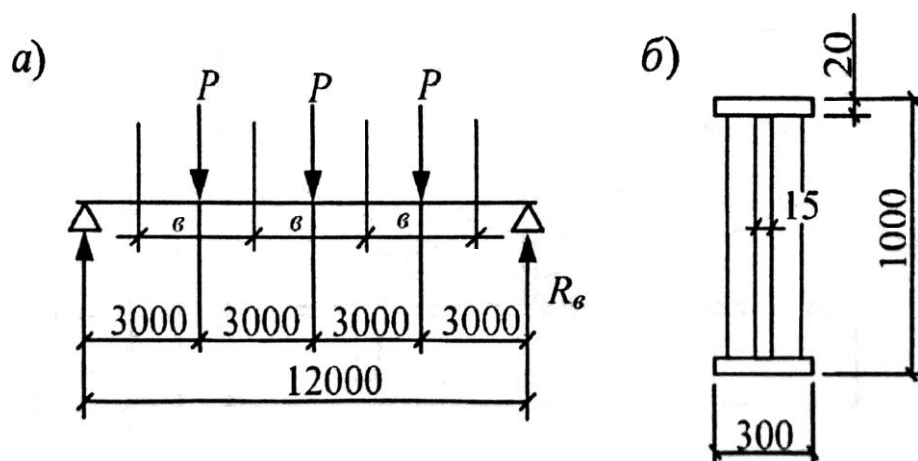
К расчёту бортовых элементов на монтажные нагрузки:
